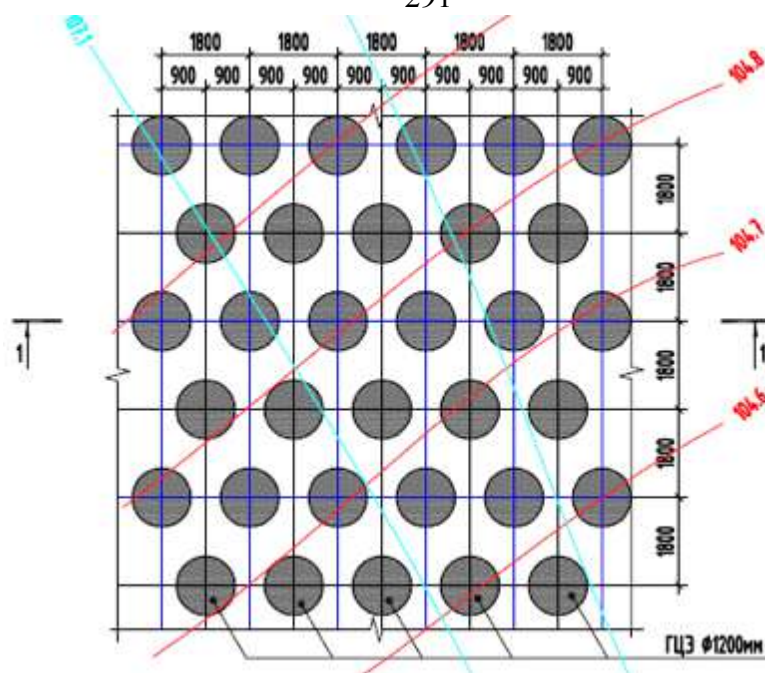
Схема размещения грунтобетонных армирующих элементов
